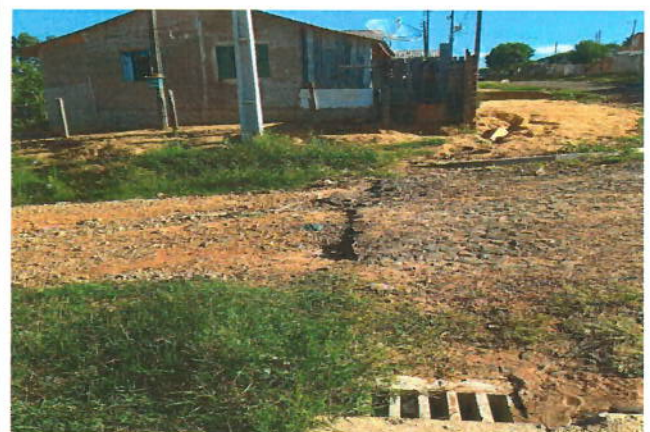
Rua Pato Branco - T2: Vista de caixas de captação de águas pluviais.
